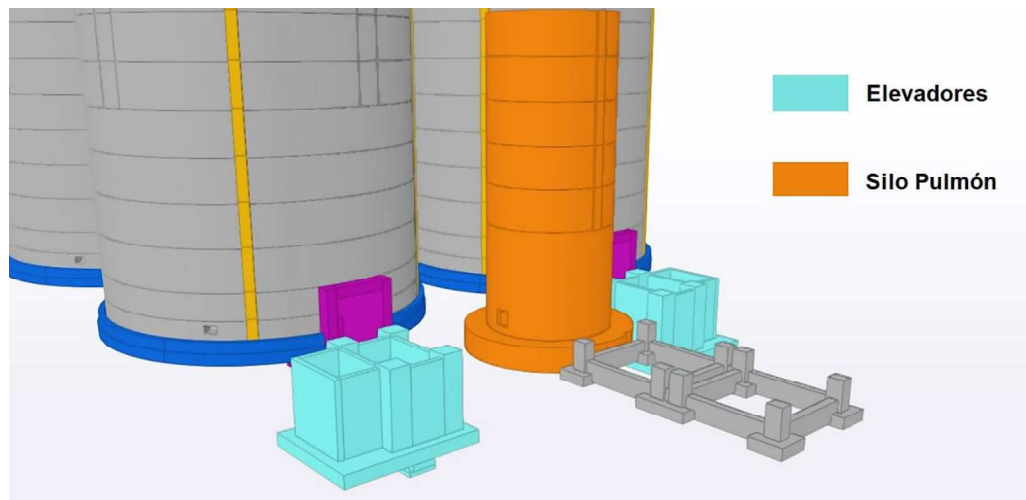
Vista Silo Pulmón y Elevadores. Elaboración propia
